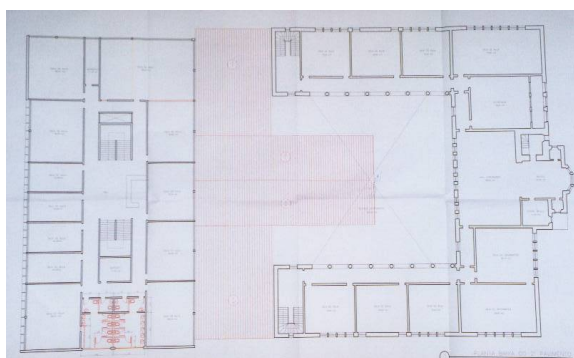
Planta baixa do 2º pav. Grupo Escolar D. Pedro II. Fonte: Departamento Geral da Rede Física da Secretaria Estadual da Educação – RJ Arquiteta Maria José de Mello
